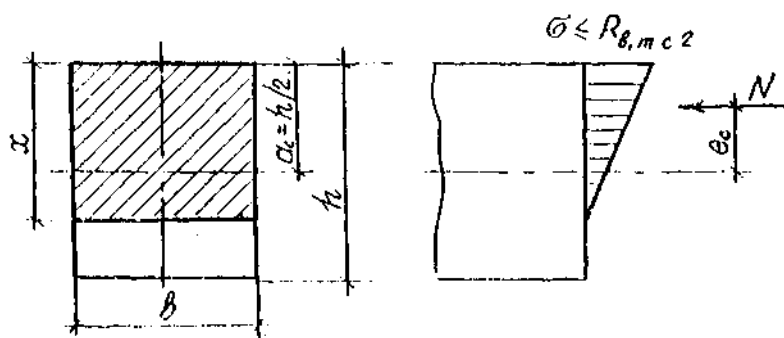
Схема к расчету бетонных сечений по трещиностойкости
